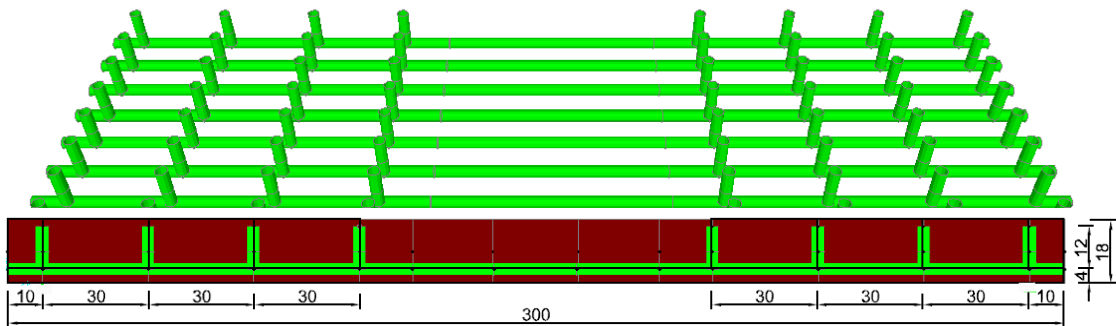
Disposição construtiva de armadura longitudinal da laje L2.
